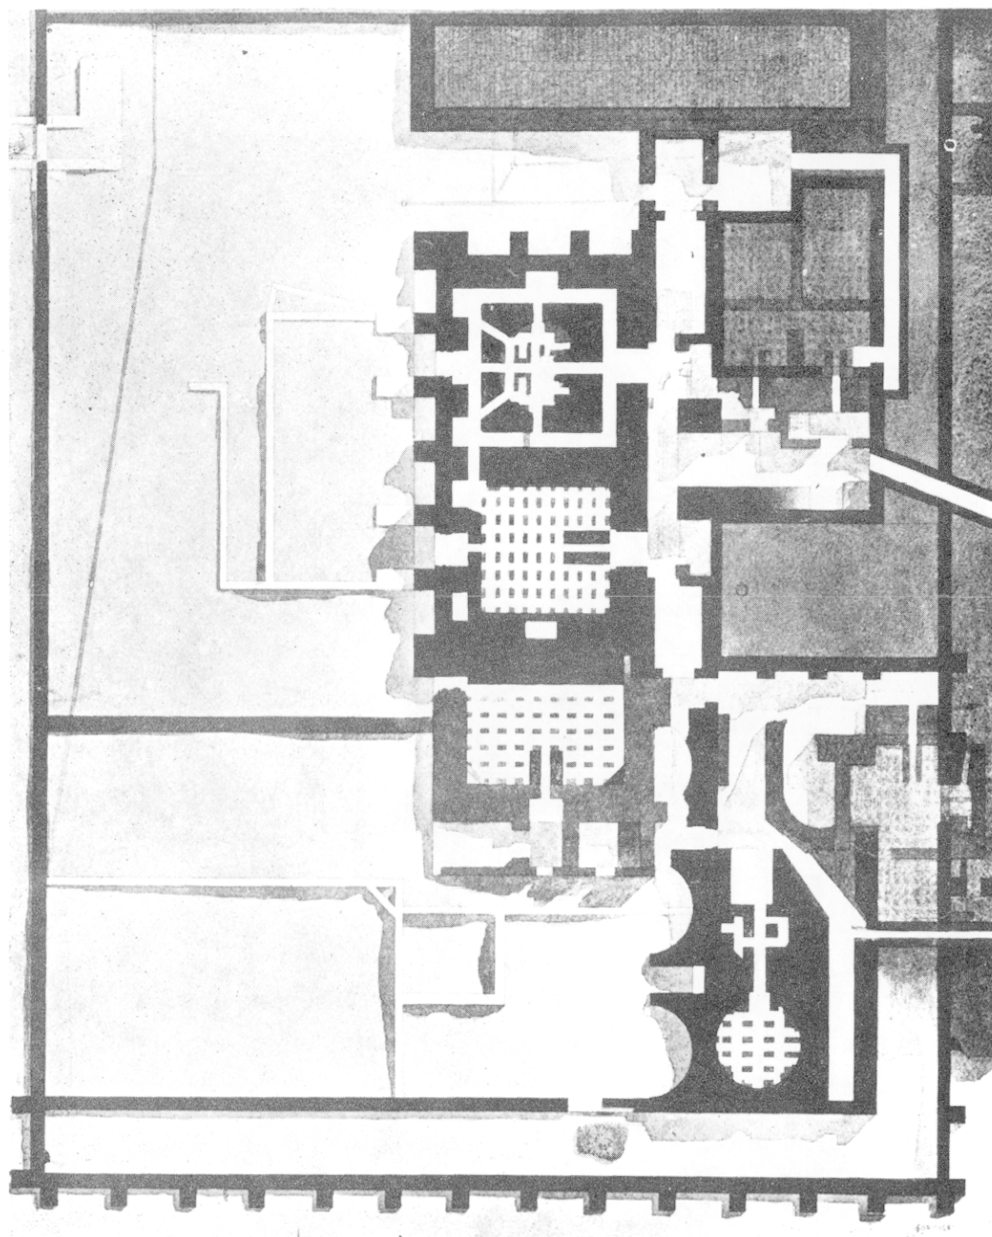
Plan des thermes, soubassements, état actuel. (Plan de C.-J. Formigé.)
